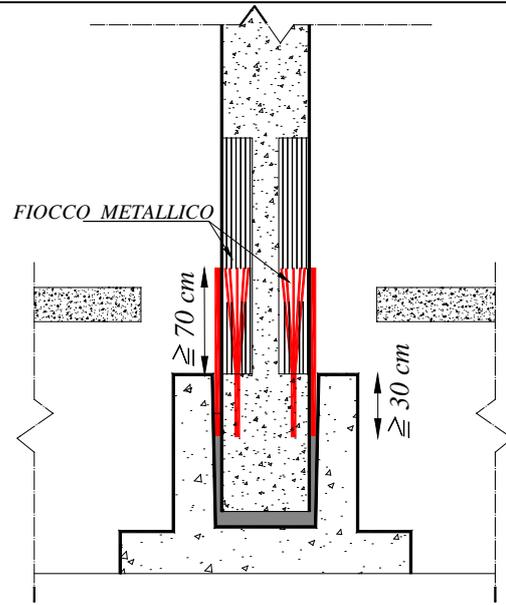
Applicazione del tessuto metallico. Sezione orizzontale
